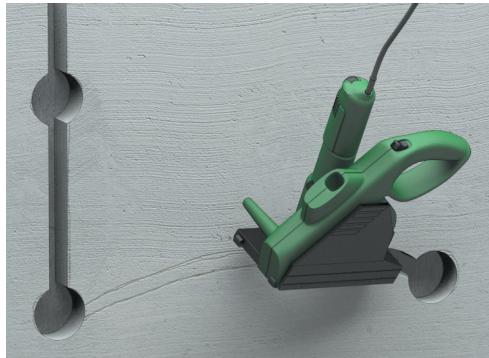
Шаг второй: при помощи перфоратора режутся отверстия под коробки и штроборезом или болгаркой делаются штробы между ними
